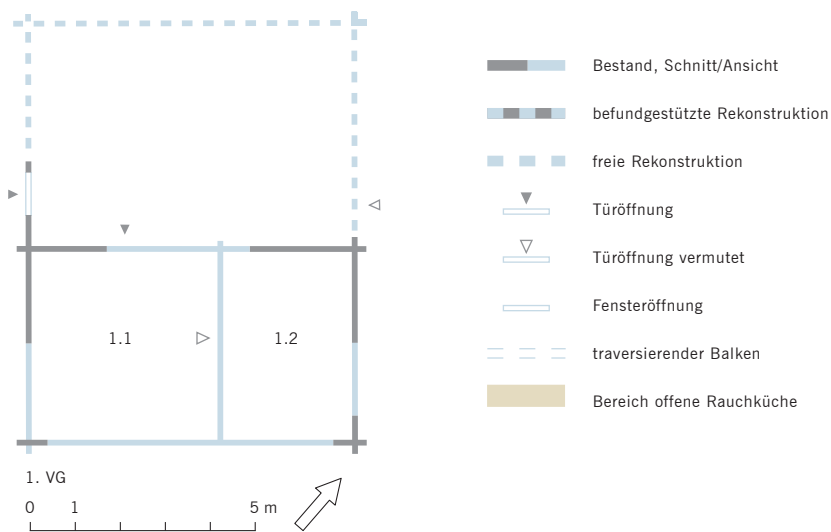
Haus Alte Baarerstrasse 7 in Zug, rekonstruierter Grundriss des ersten Vollgeschosses des Gründungsbaus.
